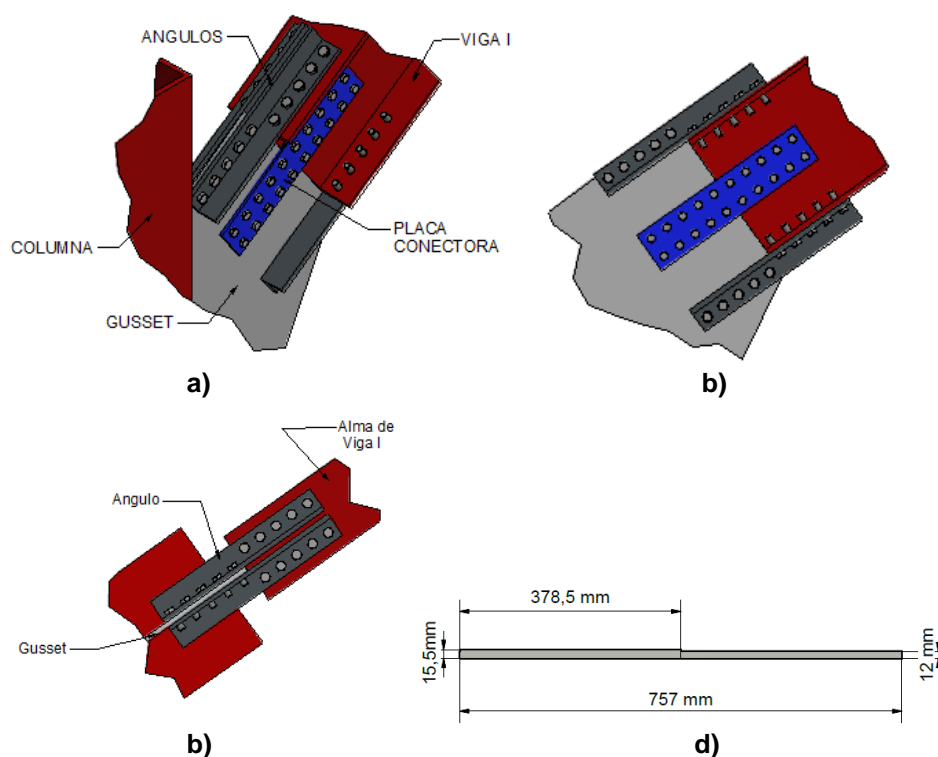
Elementos de conexión diagonal – placa Gusset: a) Detalle de ángulos conectores tipo “L” y placa conectora; b) Vista en planta de placa conectora y ángulos conectores; c) Vista de ángulo conector con pernos horizontales y verticales d) Placa conectora de sección variable.
